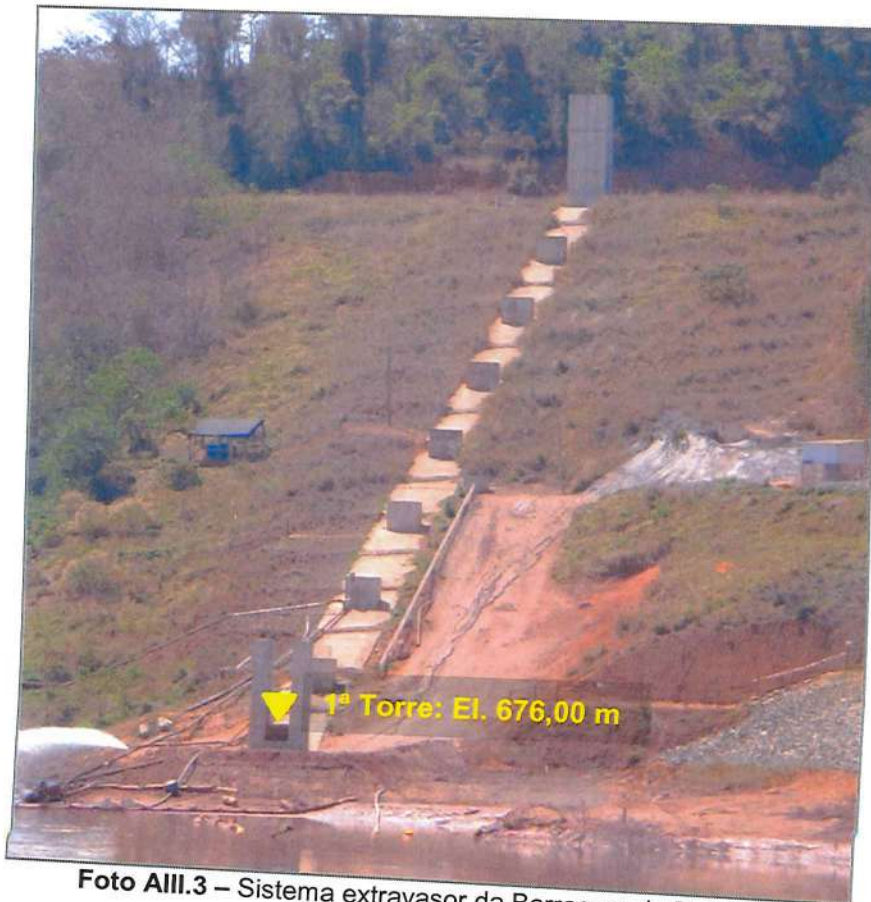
Sistema extravasor da Barragem de Rejeitos.
